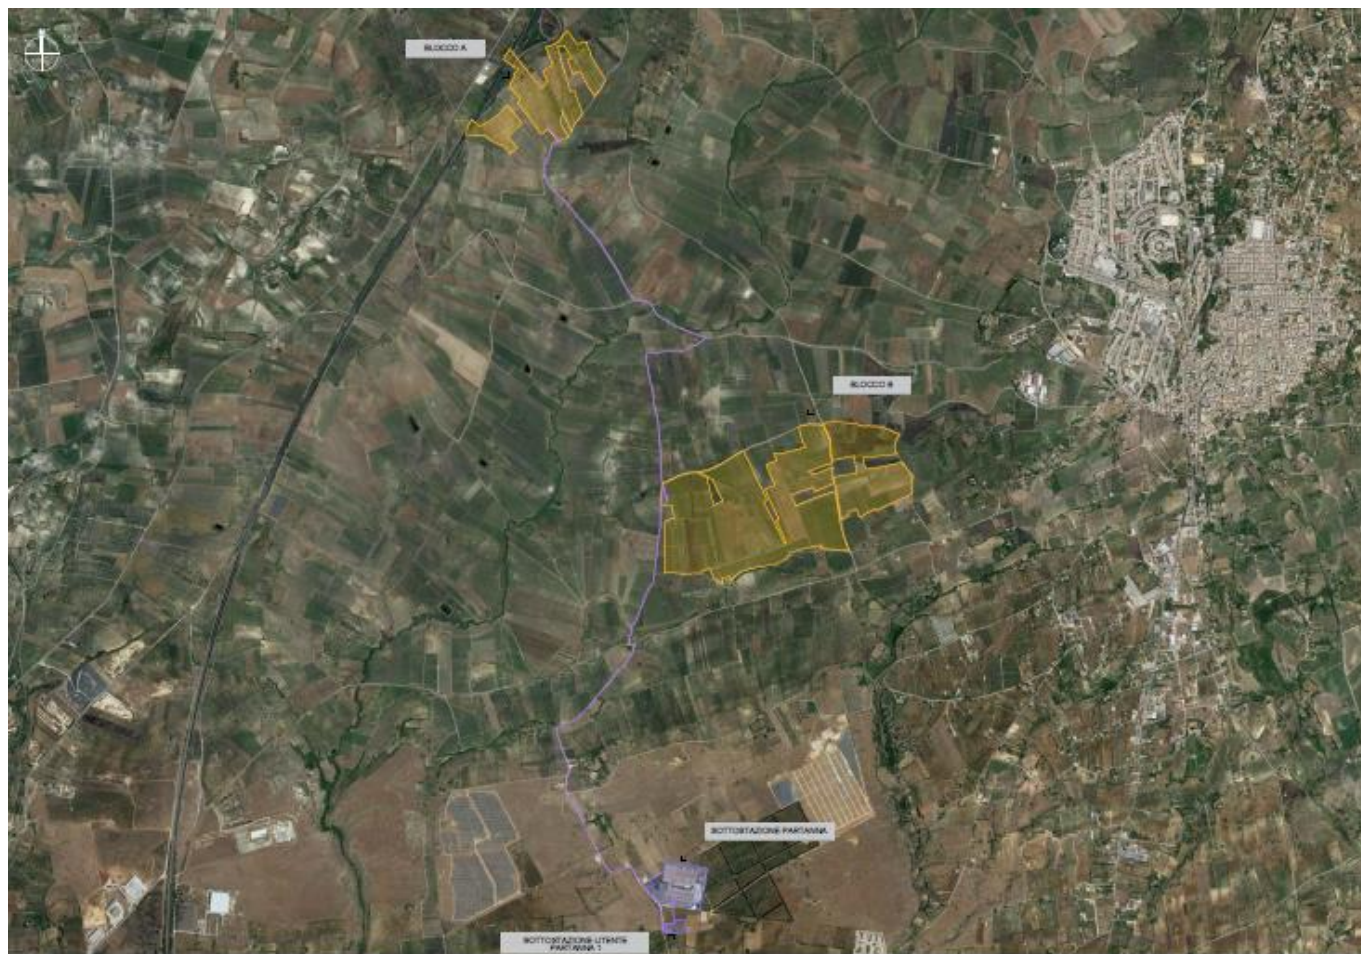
Layout di progetto. Stralcio da elaborato di progetto "INQUADRAMENTO CAVIDOTTO DI COLLEGAMENTO SEU FV PARTANNA 1 SU ORTOFOTO"
